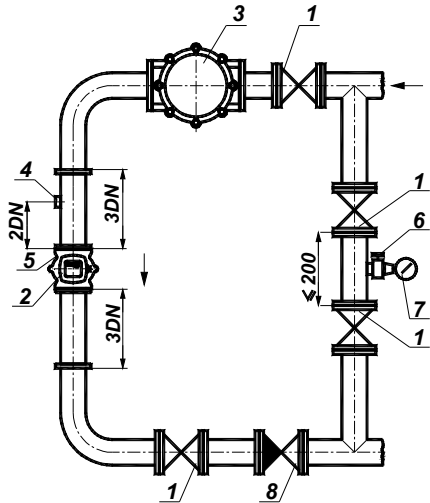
Схема монтажу лічильника (з байпасом) на вертикальному газопроводі
